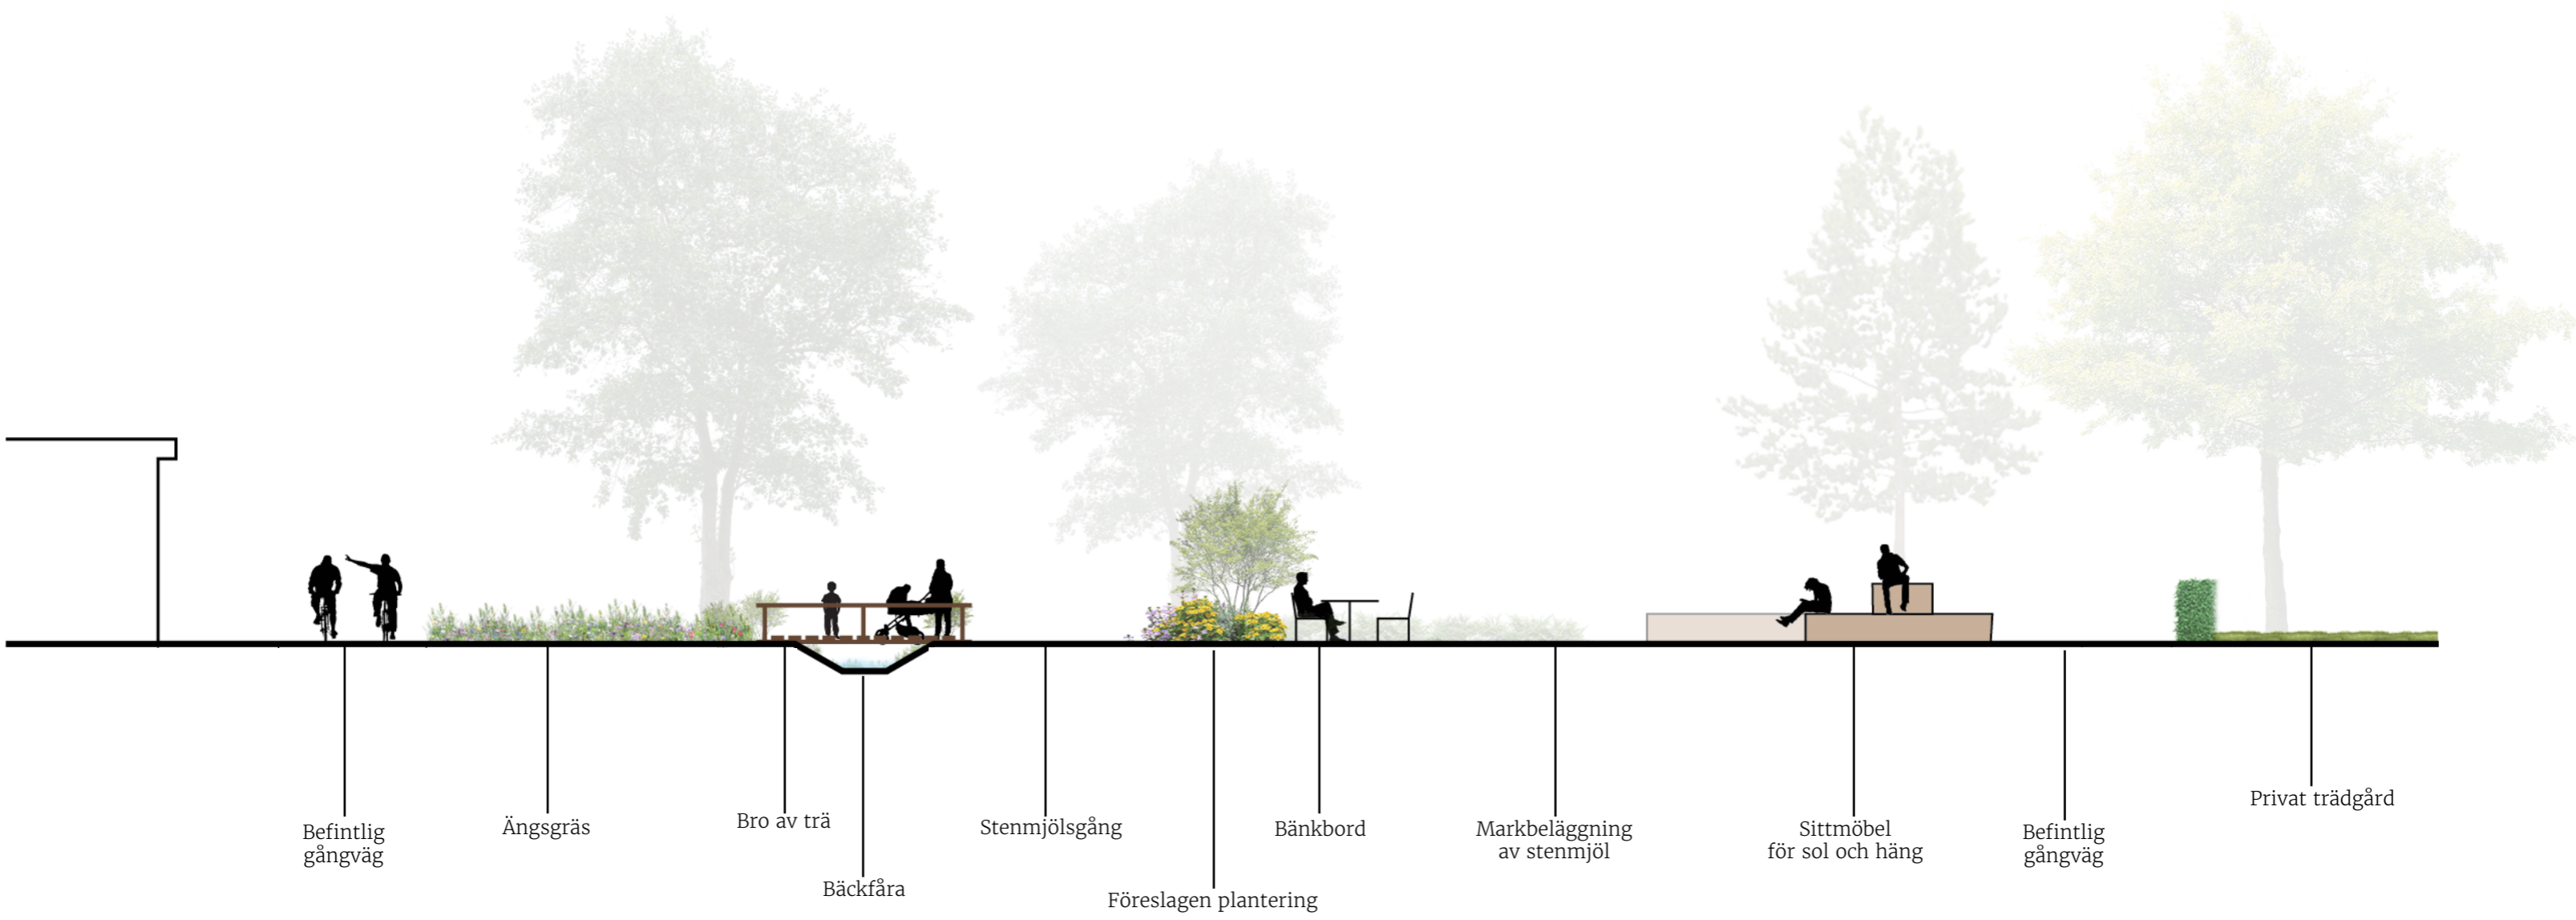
Illustrationsplan cirka 30 år efter plantering.
